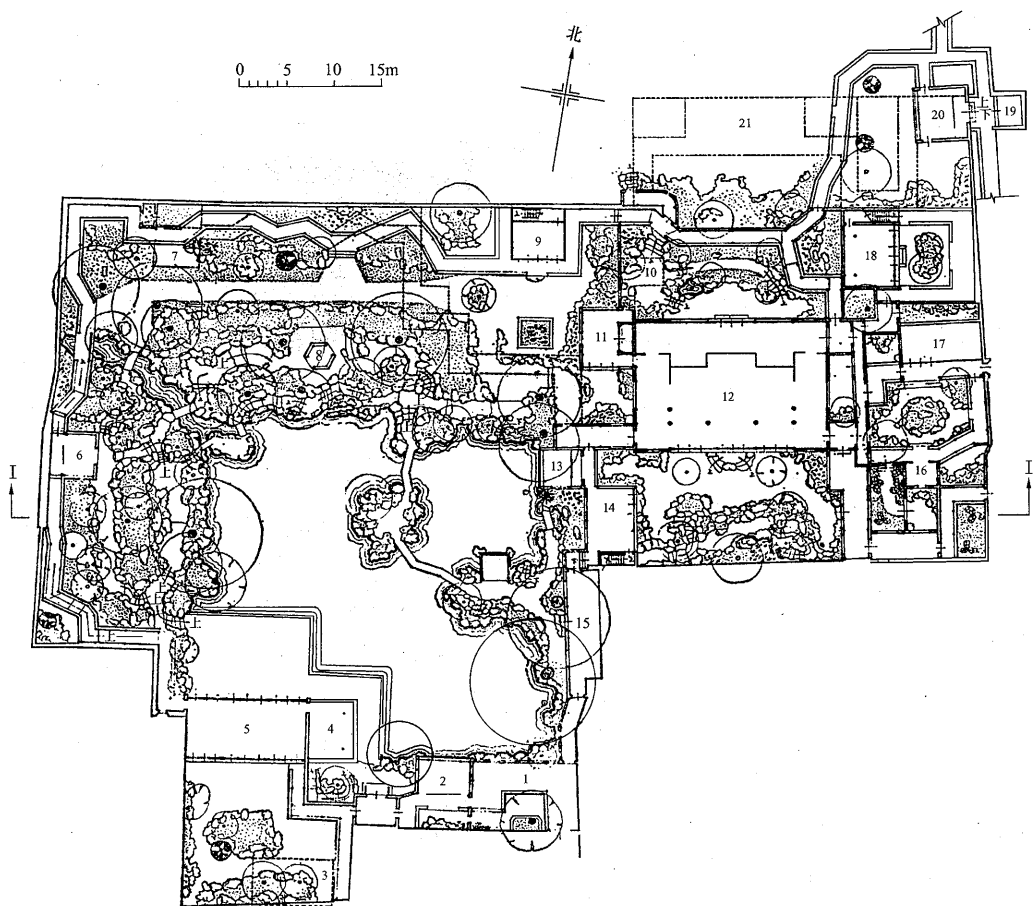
江苏苏州市寒碧庄（今留园）平面图
